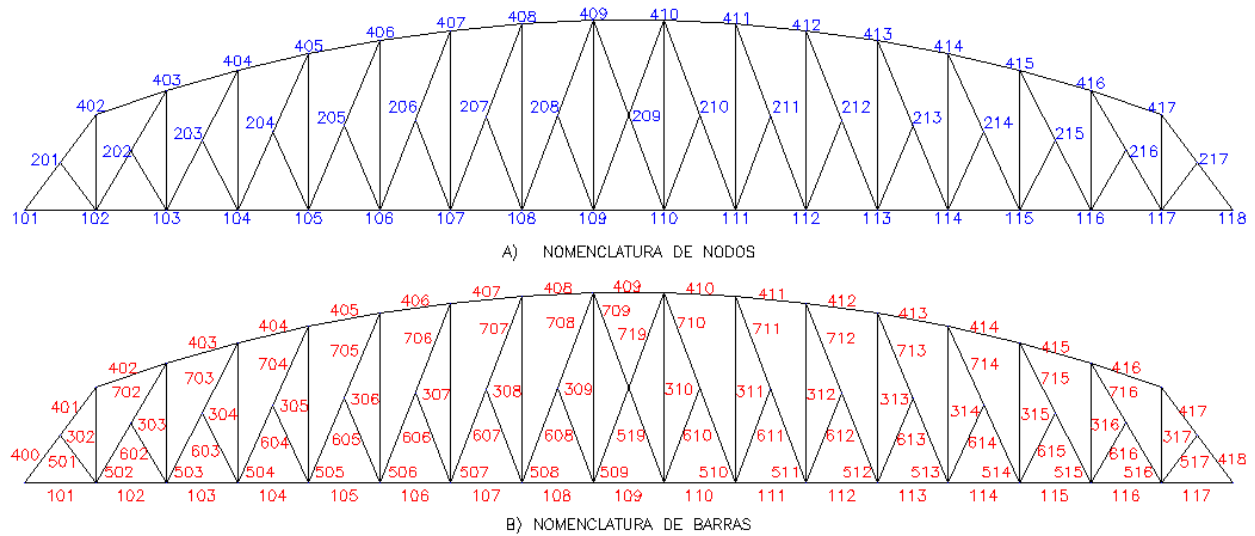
Desglose de miembros. Geometría Corner Bracing
